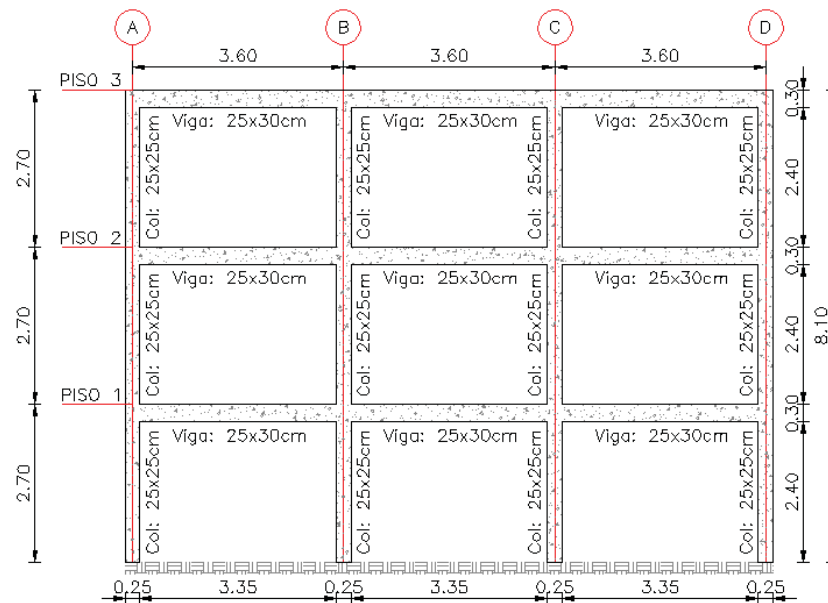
Geometría en elevación pórticos 1,4,A,D (Ejemplo de aplicación)
